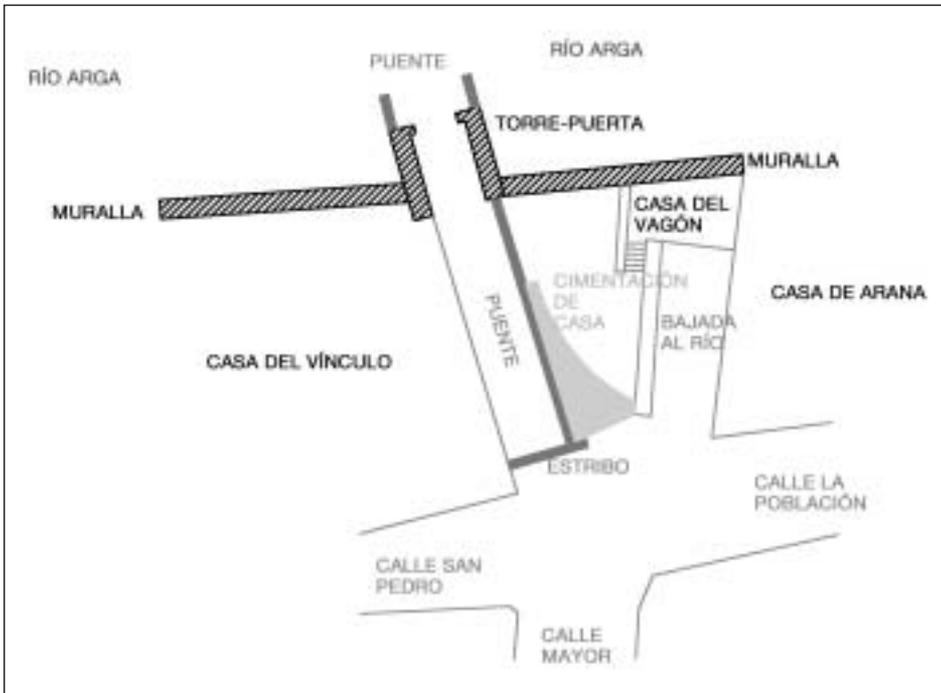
Plano de situación de la excavación, con situación de los distintos elementos arquitectónicos de referencia y de la estructura del puente recuperada
